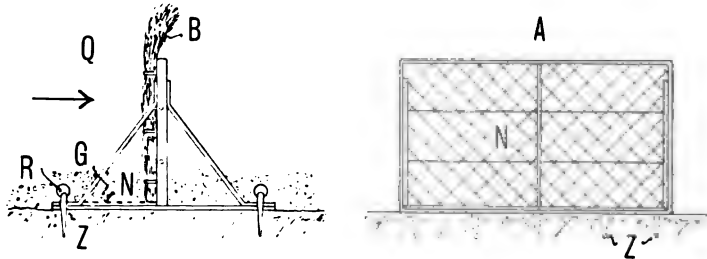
Eisernen Leitwerke, Bauweise Doell.
